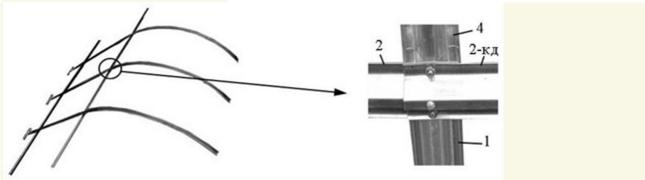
Детали №2-к и №2-кд должны быть с одной стороны.
